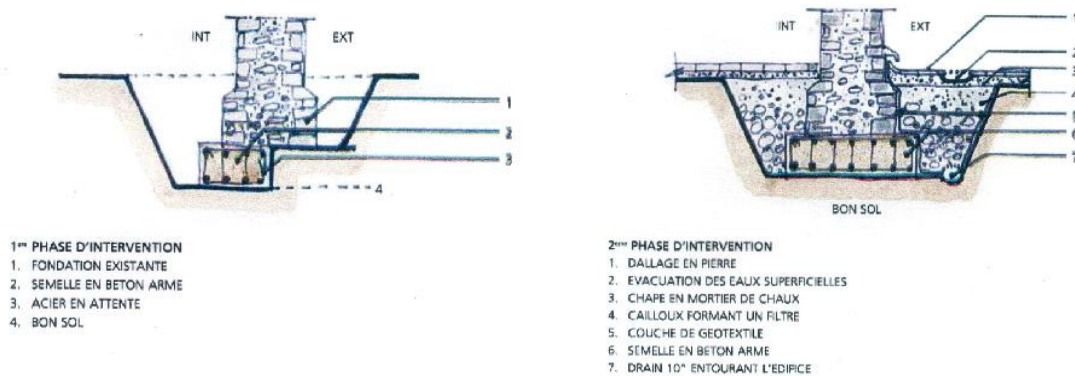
Reprise en sous œuvre d'une semelle en béton armé
